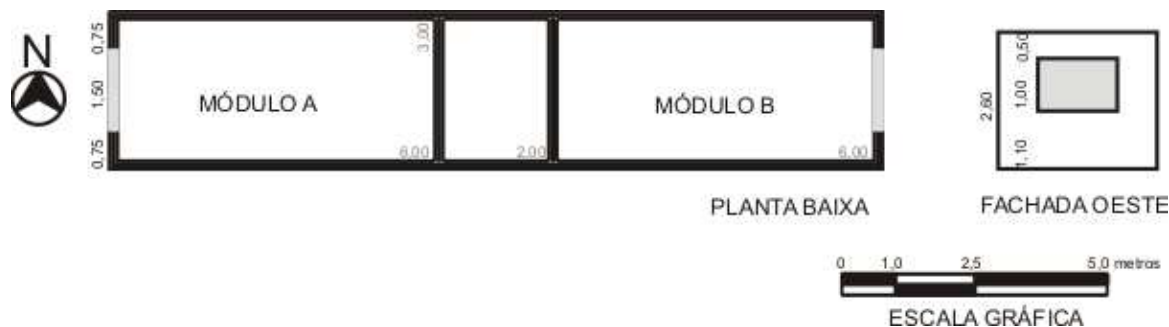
Modelo avaliado: planta baixa e elevação oeste
